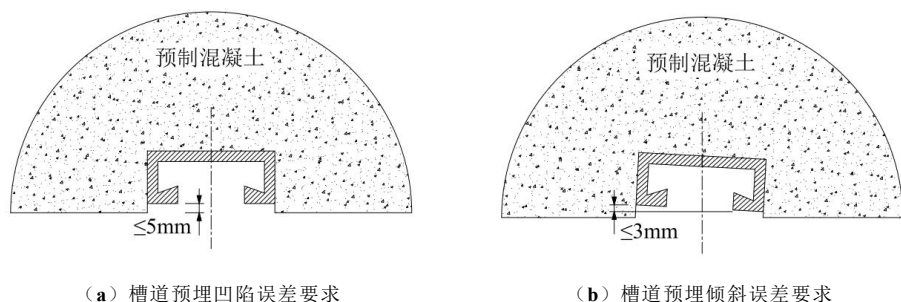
预制混凝土槽道预埋断面误差要求
